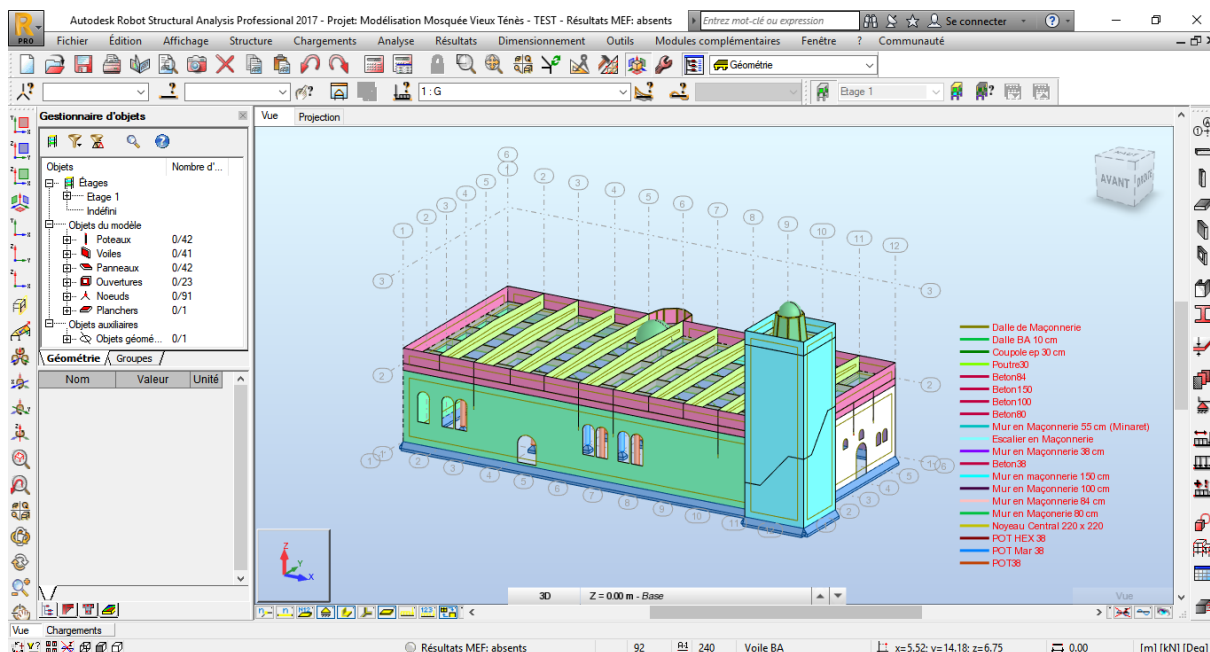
Modélisation des poutres en béton armé (Auteur, 2018)
